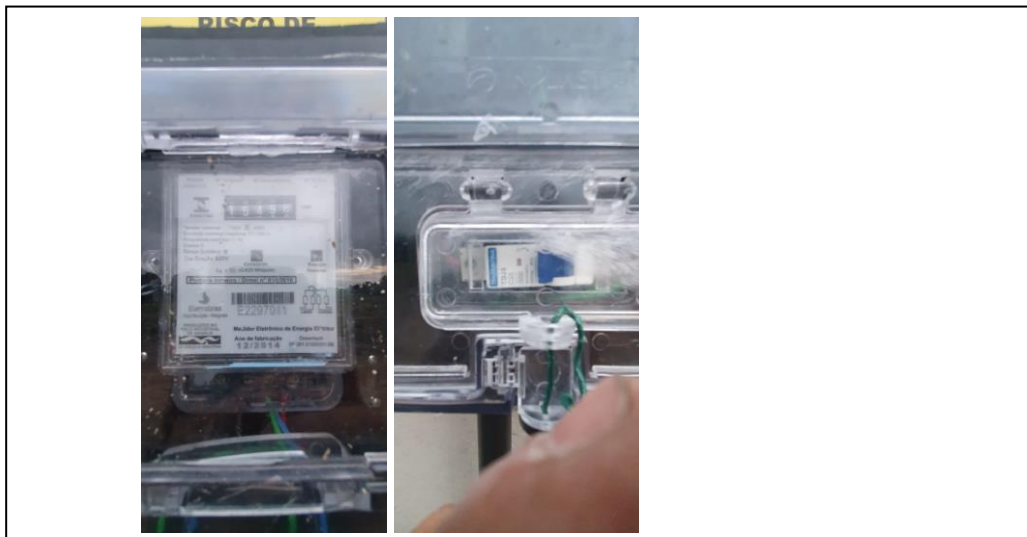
Foto da caixa de medição ou do local de instalação da futura caixa de medição.
